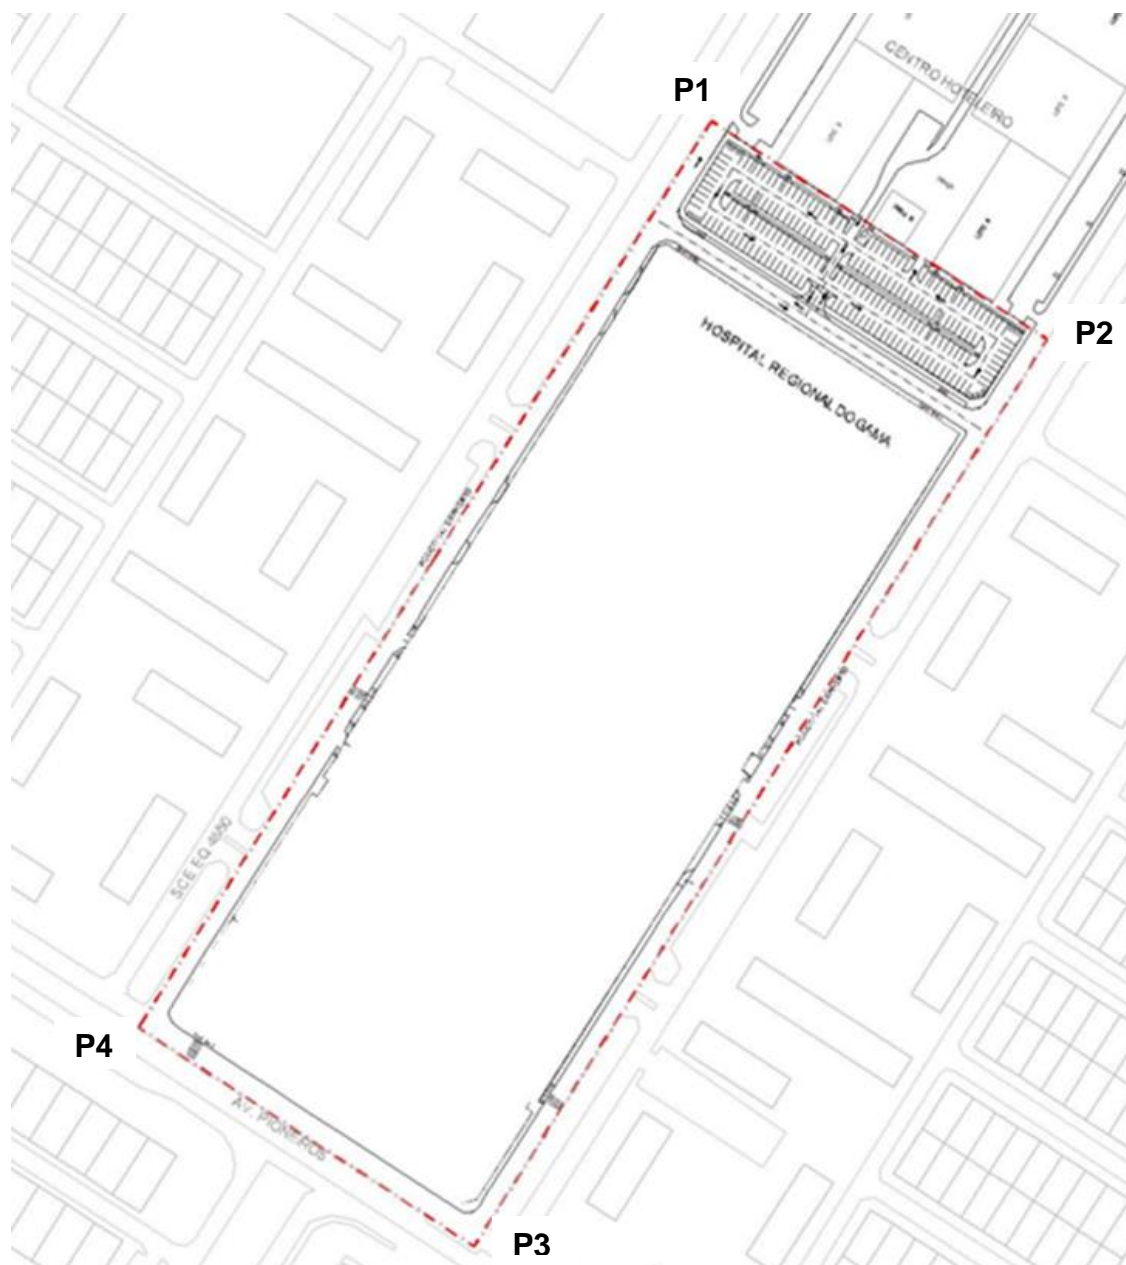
CROQUI DA POLIGONAL DE PROJETO.
